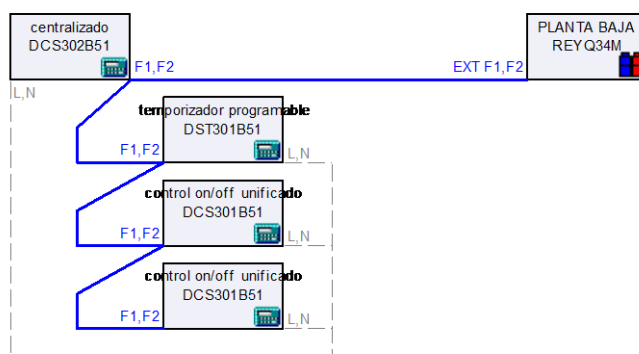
Esquema conexión control centralizado VRV. PLANTA BAJA
